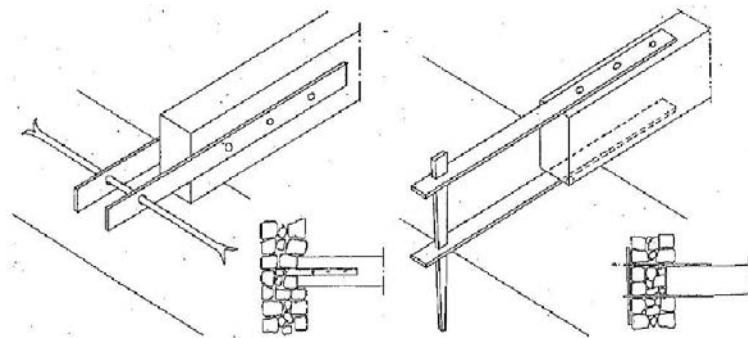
Connexions poutres/murs renforcées par des pièces métalliques visibles ou non du parement (d'après Coignet [53])
